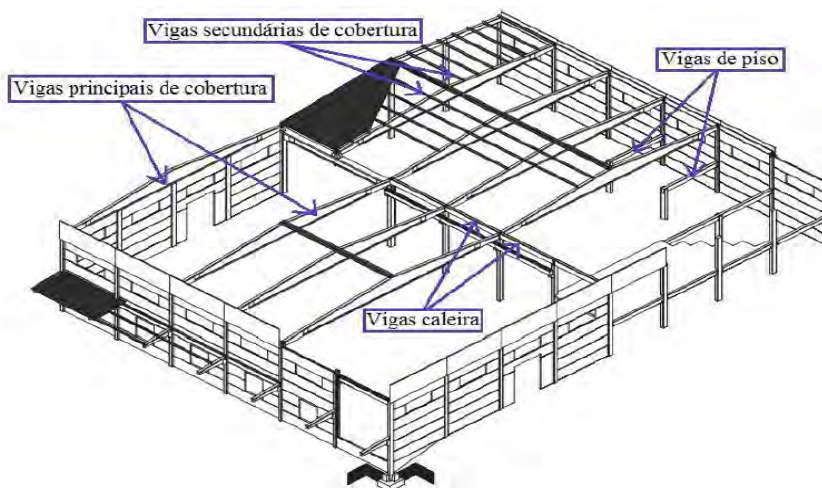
Diferentes aplicações estruturais de vigas pré-fabricadas (FIP (2004)).
